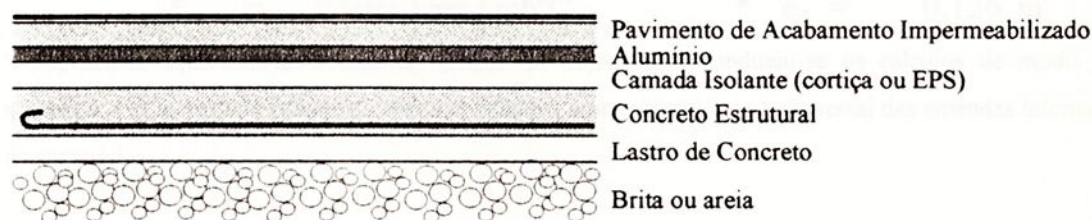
Corte do piso da câmara frigorífica considerando alvenaria com tijolos maciços, blocos de concreto ou blocos cerâmicos
